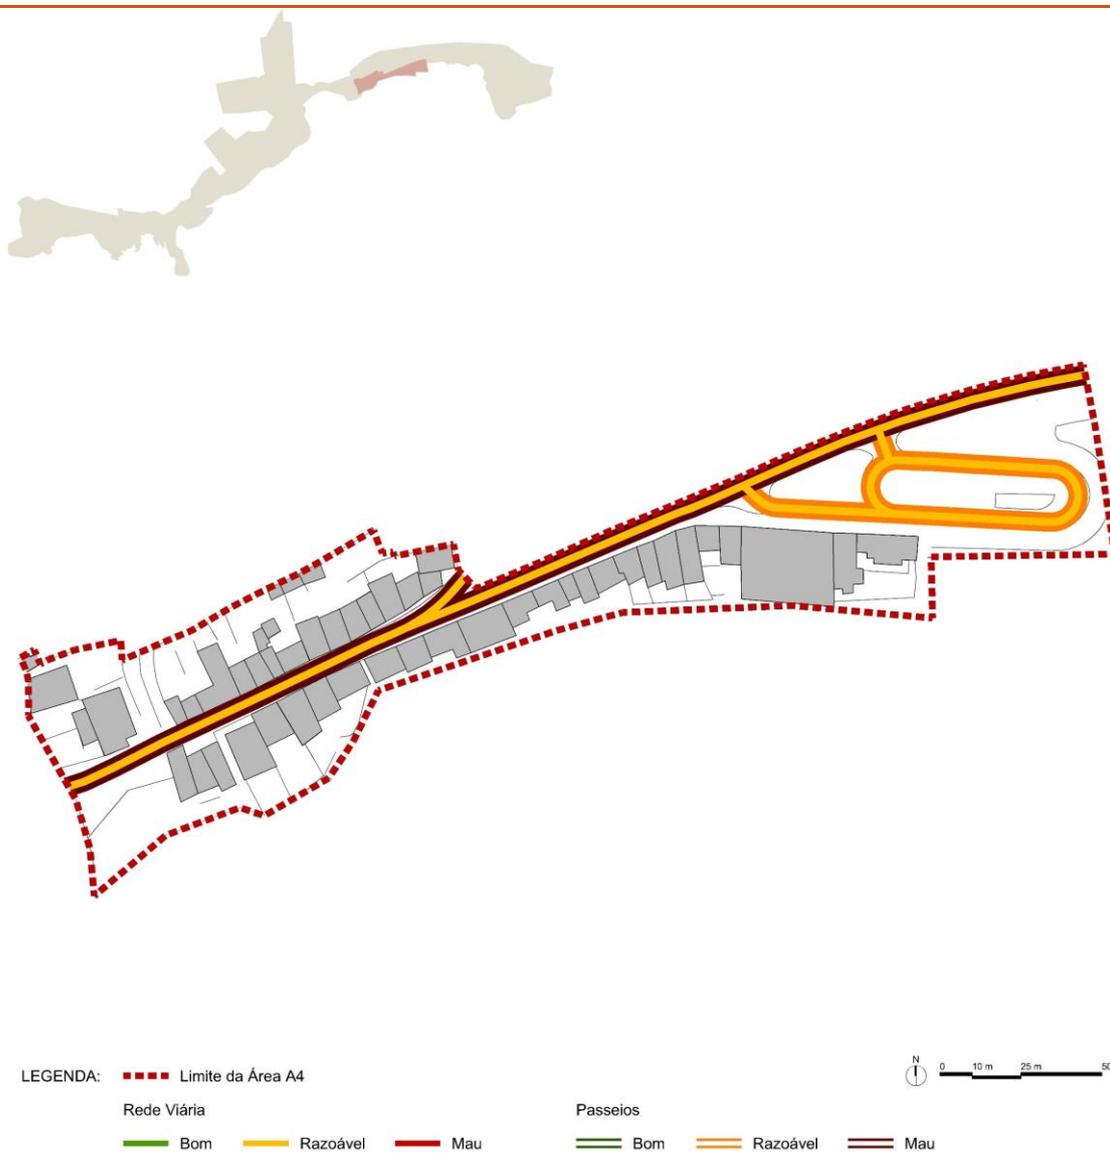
Levantamento de campo da Área A4 – Estado de conservação vias e passeios.
